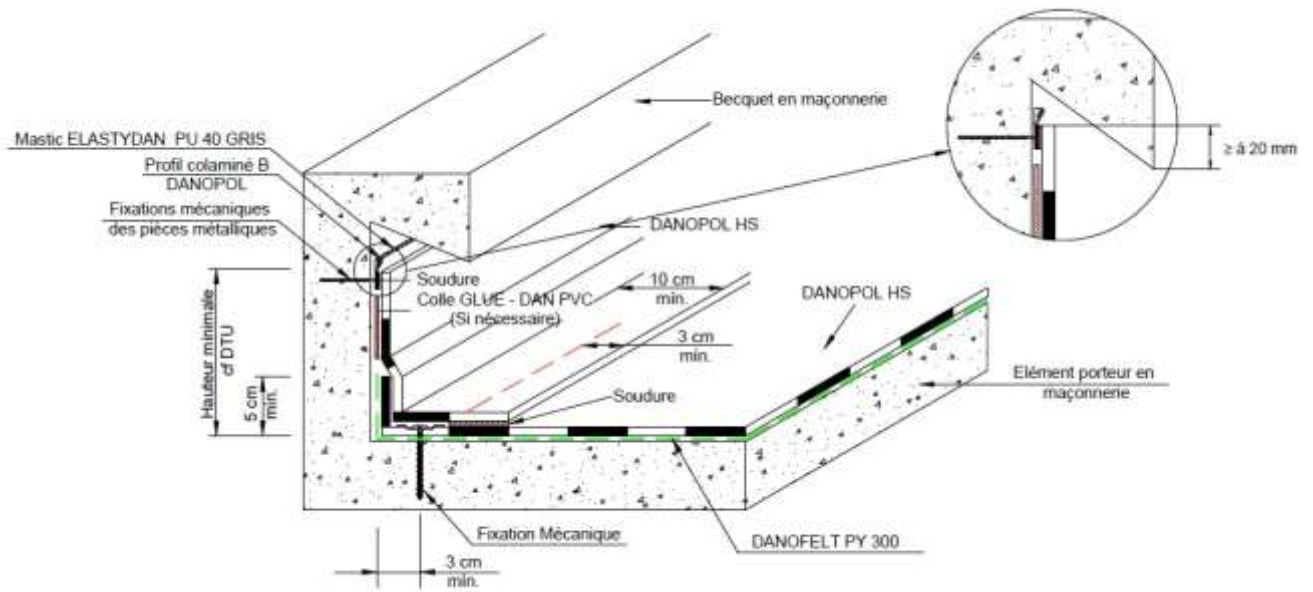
Relevé d'étanchéité avec profil colaminé B (maçonnerie sans isolation)
